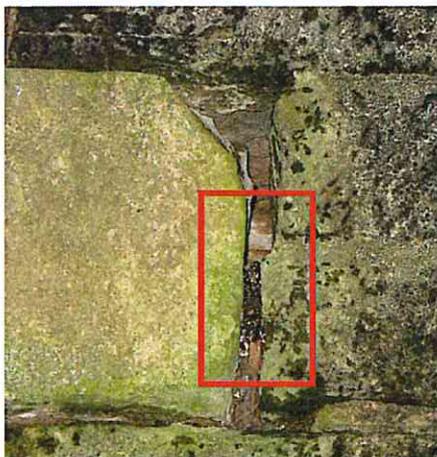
Planche photographique de l'ouvrage de la RD 103 de Maizières-sur-Amance avant travaux
